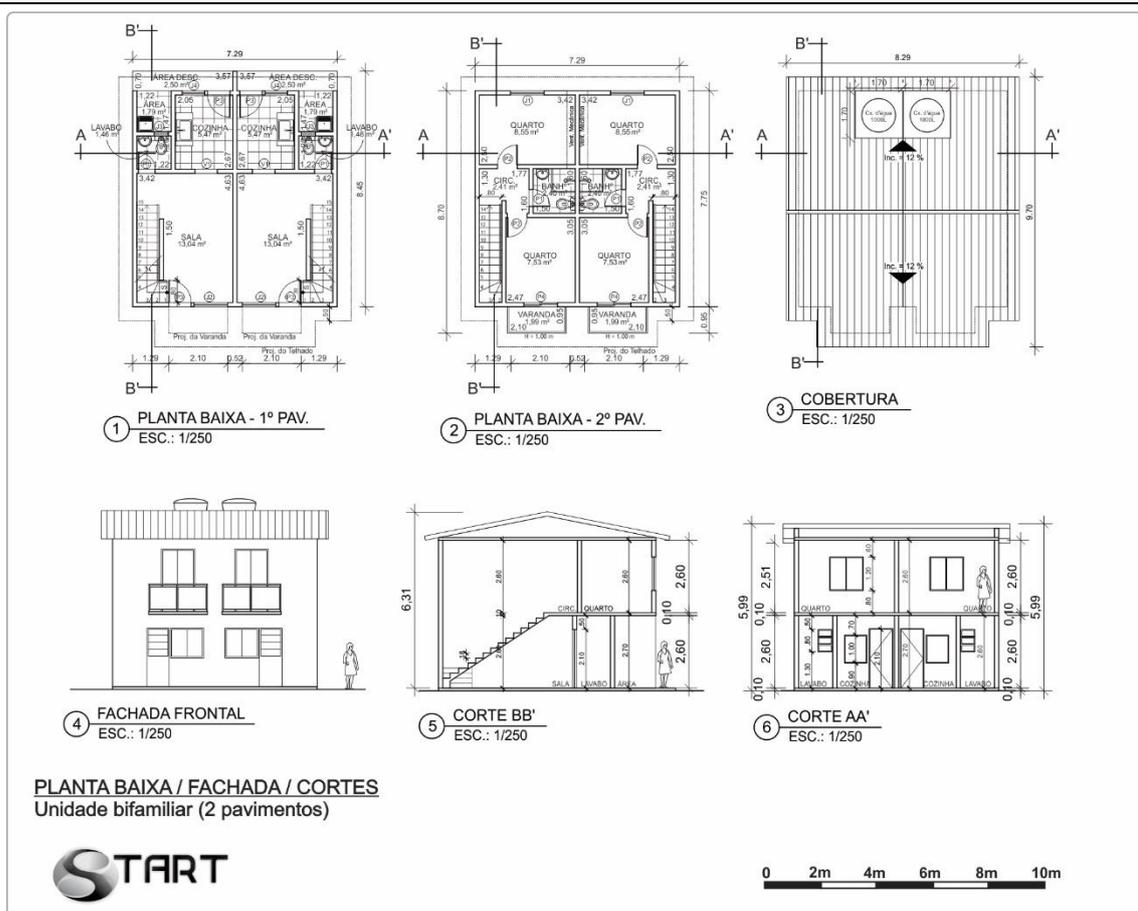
Planta baixa, fachada e cortes da unidade bifamiliar de 2 pavimentos
